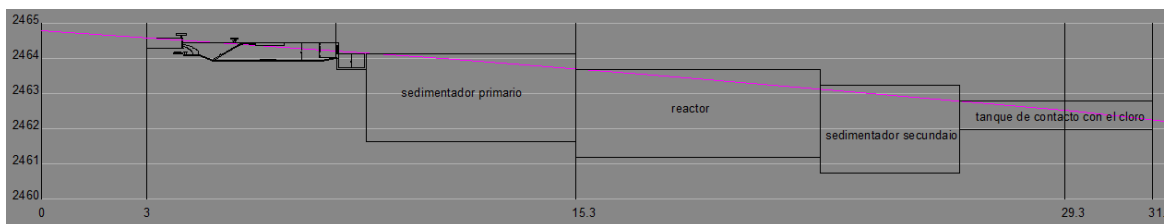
Perfil del terreno. La escala horizontal y es igual a la horizontal.
